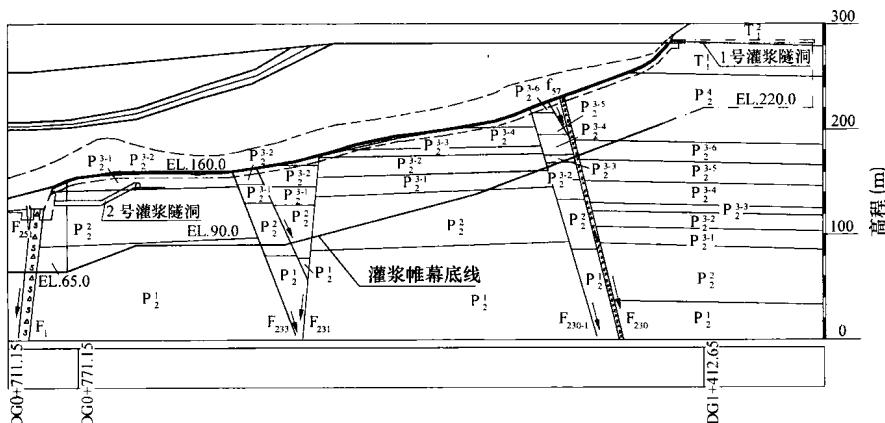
右岸坝基沿帷幕灌浆轴线工程地质剖面图
